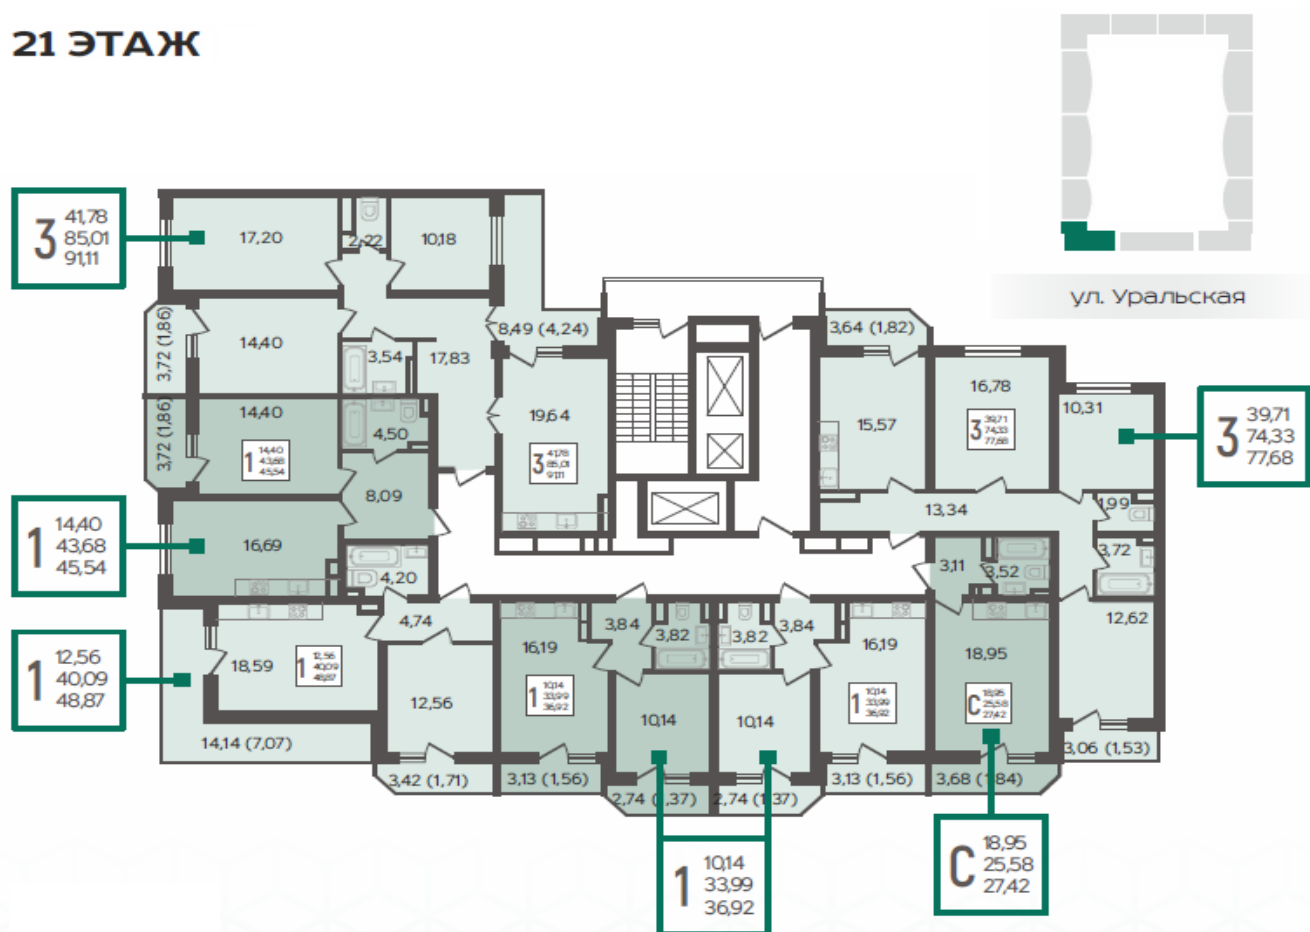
План 21 этажа БС-1 ЖК URAL
